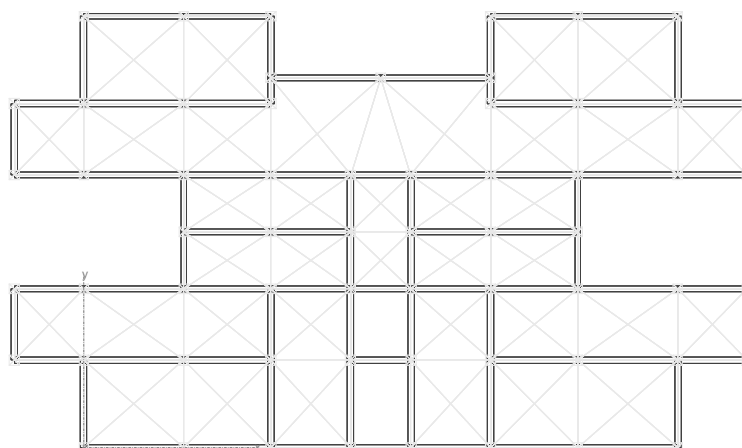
Vista en planta del modelo de cálculo con representación de las vigas y las cruces de San Andrés que simulan los forjados
